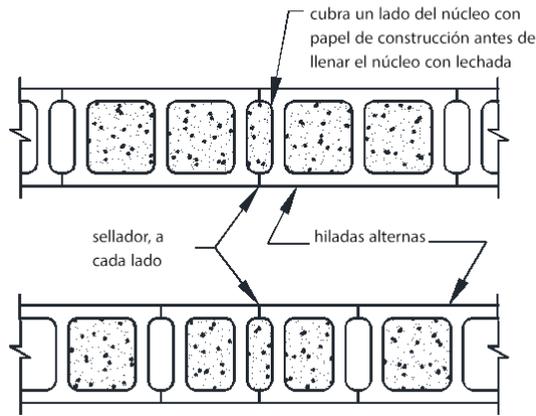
DETALLES DE JUNTAS DE CONTROL PARA MAMPOSTERÍA
